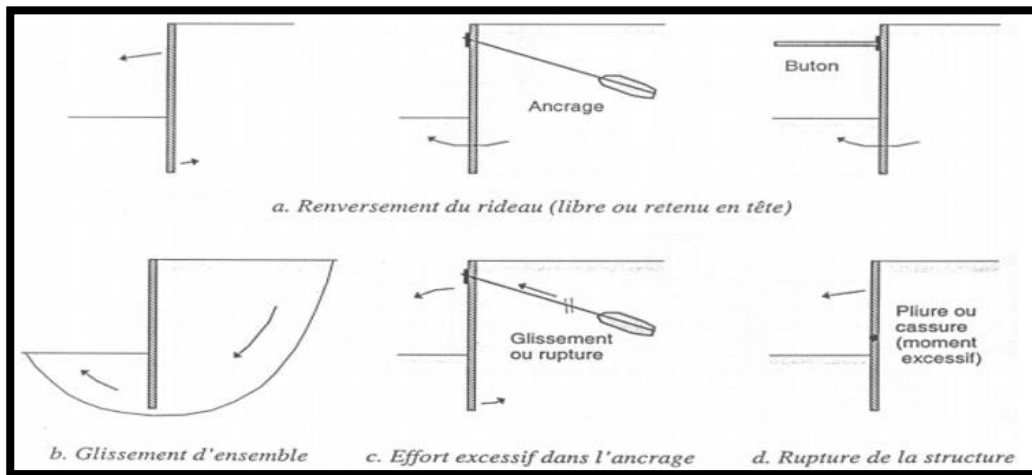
Mode de rupture d'un mur de palplanches (2)
